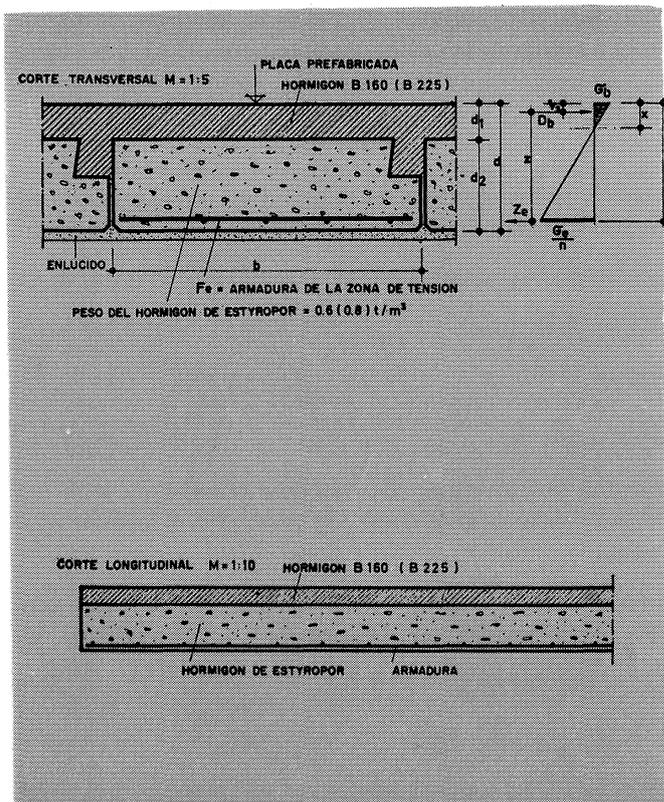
Techo de elementos prefabricados con hormigón de Styropor:
